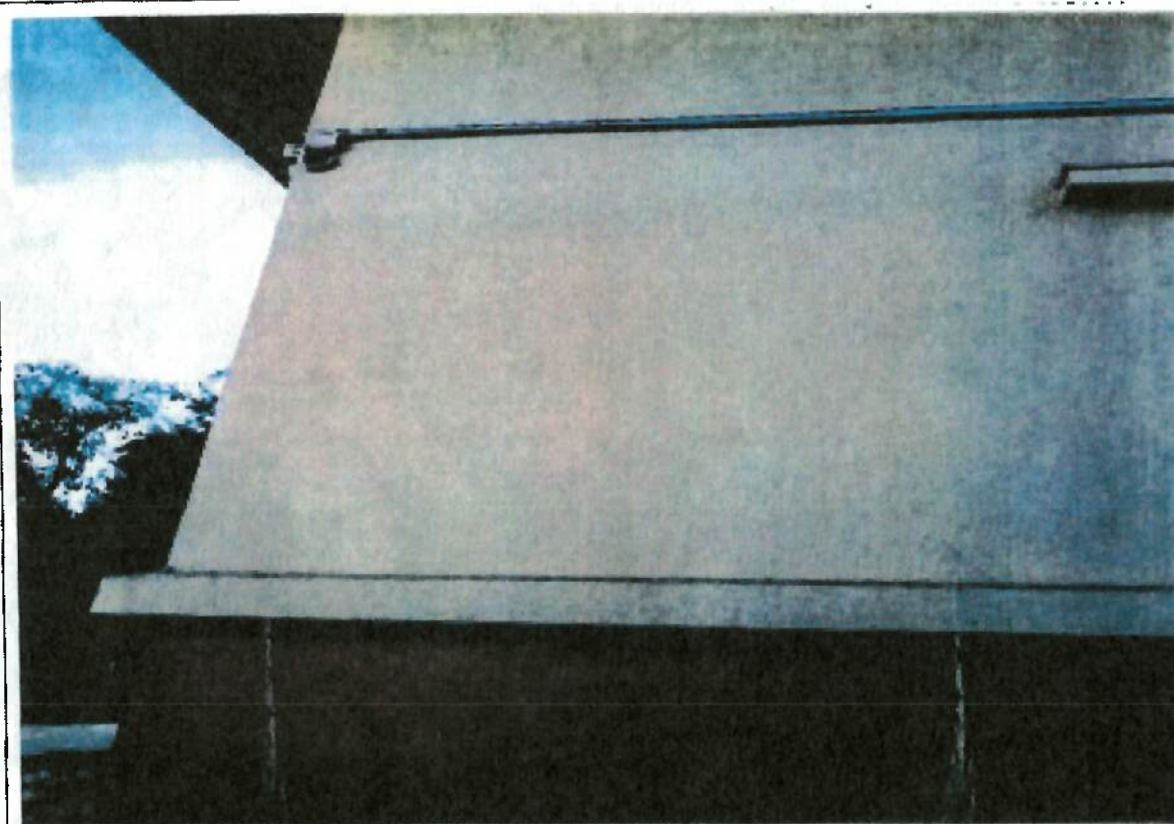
Situație existentă – Fisuri verticale și înclinată în parapet zona curba, parter, Corp C1-Tronson A
